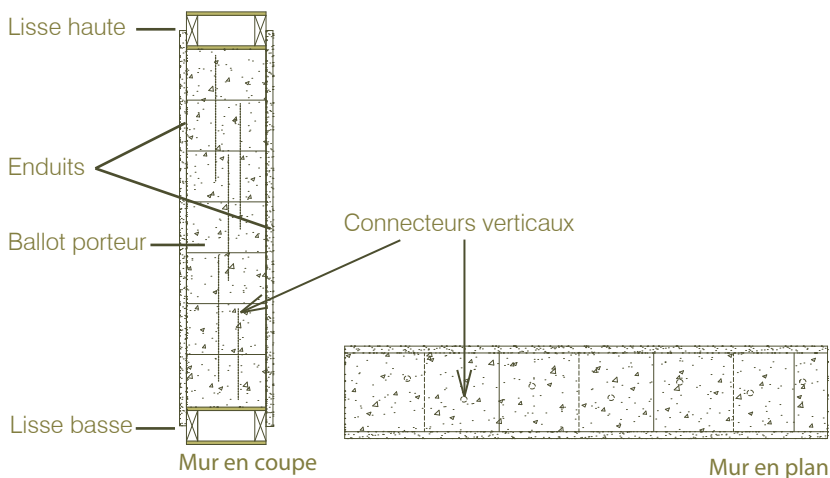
Vue en coupe et en plan du système Nebraska.
